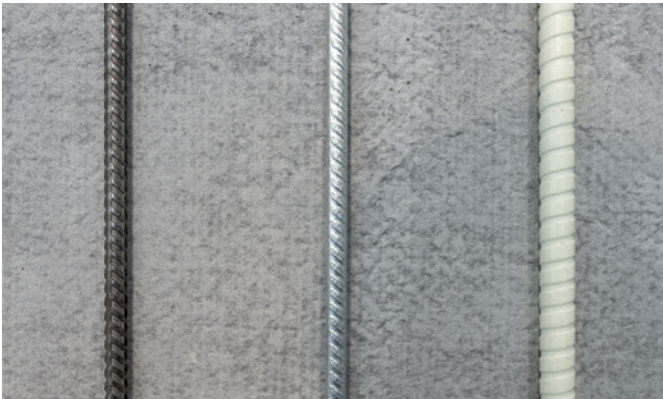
Unterschiedliche Bewehrungsarten (v. l.: Betonstahl, verzinkter Betonstahl, GFK-Bewehrung)
